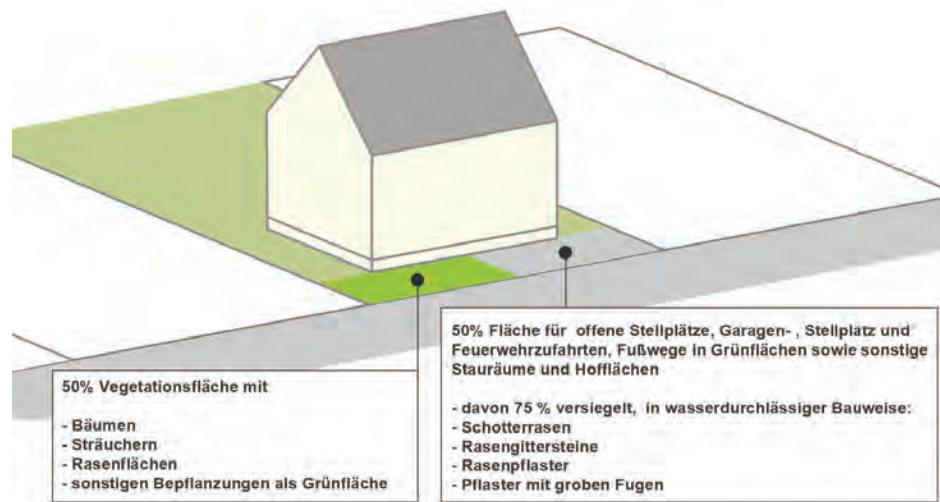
Prinzipdarstellung Versiegelung unbebauter Flächen
